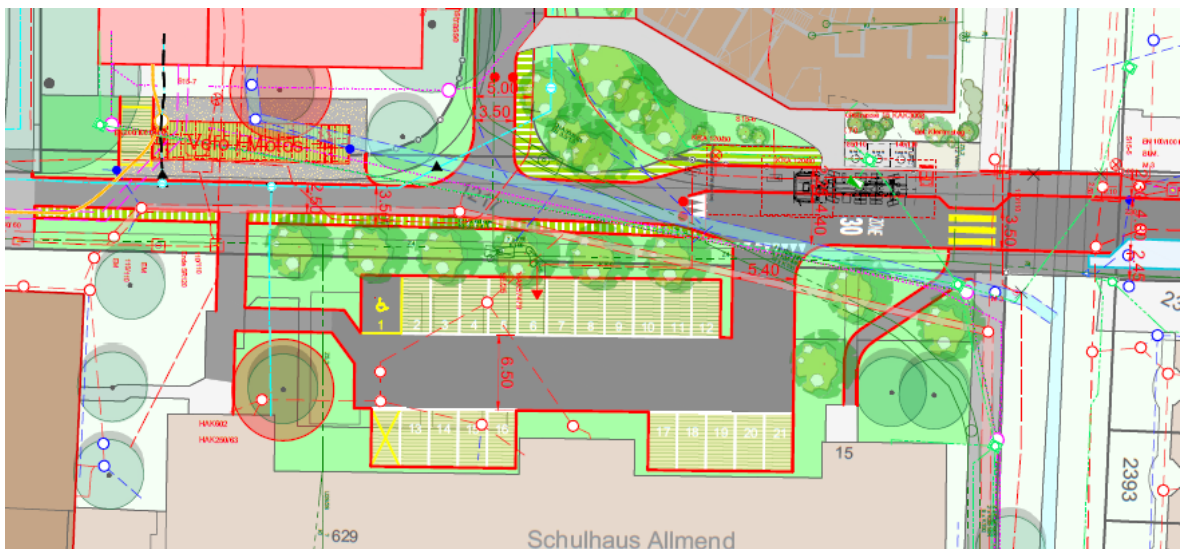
Planausschnitt Überlagerung Werkleitungen und BGK Schulhausstrasse
